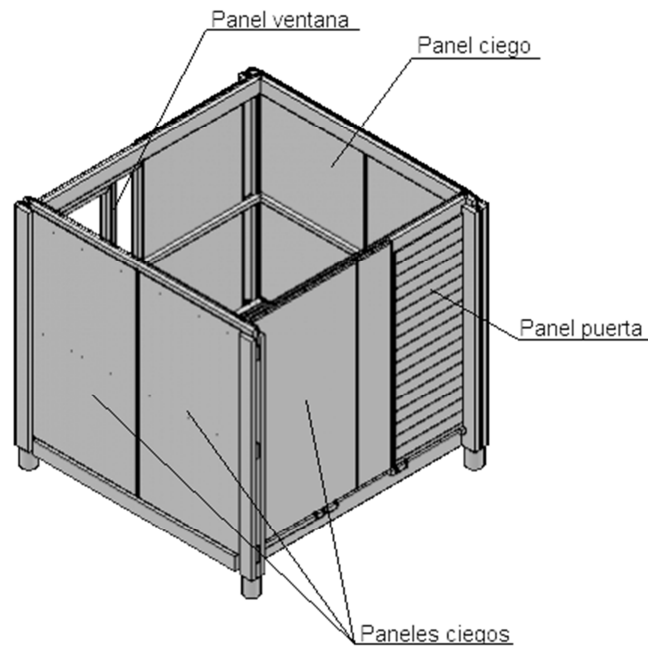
Esquema de la estructura resistente en conjunto con paneles puerta, ventana y ciegos. Fuente: Documentación provista por TECHO.
